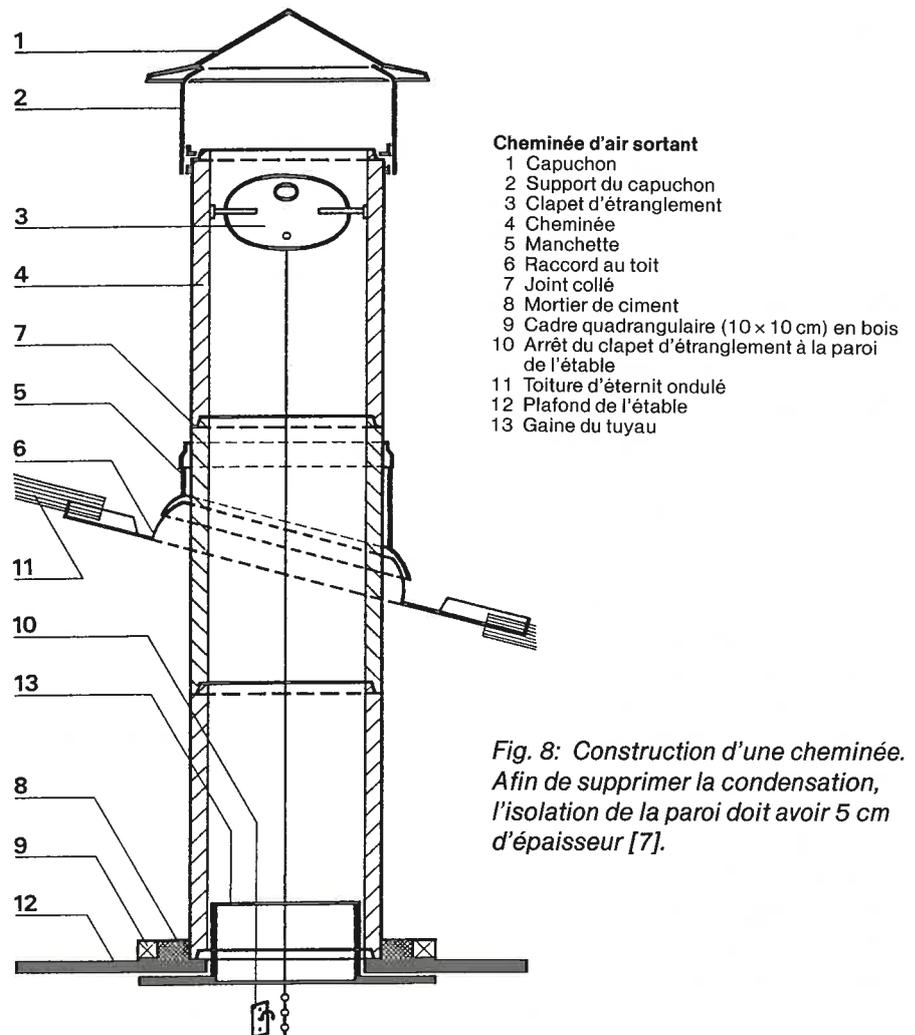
Construction d'une cheminée. Afin de supprimer la condensation, l'isolation de la paroi doit avoir 5 cm d'épaisseur [7].
